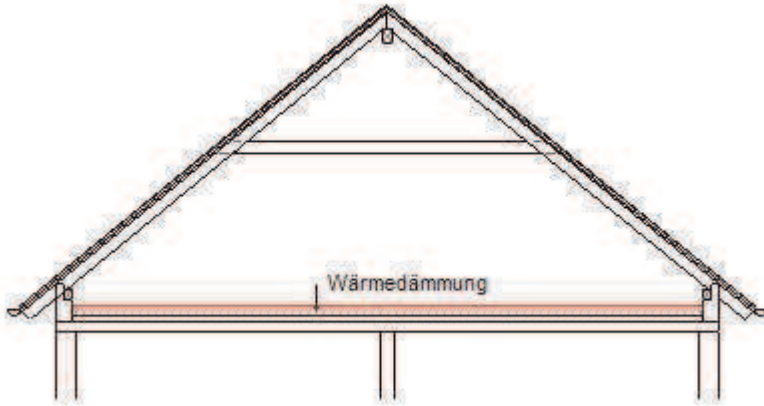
Dach unbeheizt, Dämmung Dachgeschossfußboden
